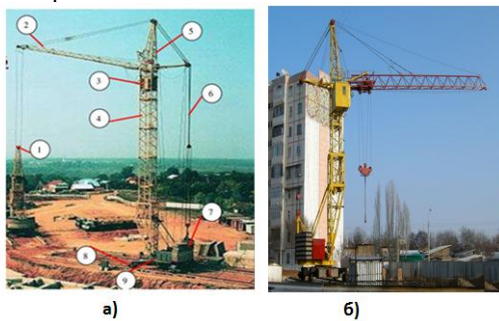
Башенные краны с поворотной башней, а) с подъемной стрелой; б) со стрелой балочного типа: 1-рабочий орган, 2-стрела, 3-кабина, 4-башня, 5-поворотная головка, 6-канатно-блочная система, 7- противовес, 8-ходовое устройство, 9-опорно-поворотный круг.
